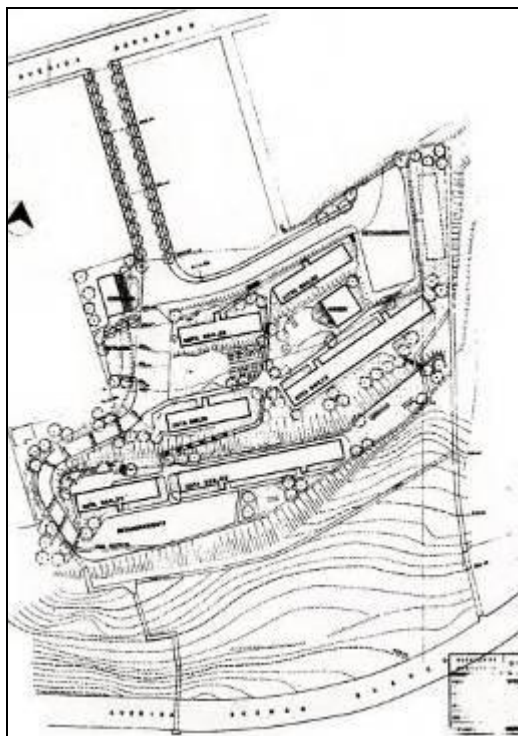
c UC Pinar Alto. Plano de Conjunto (1954)
